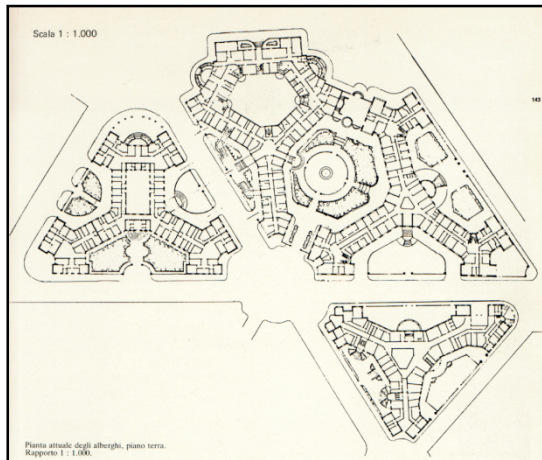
Grundriss der Massenhoteles Sabbatinis
